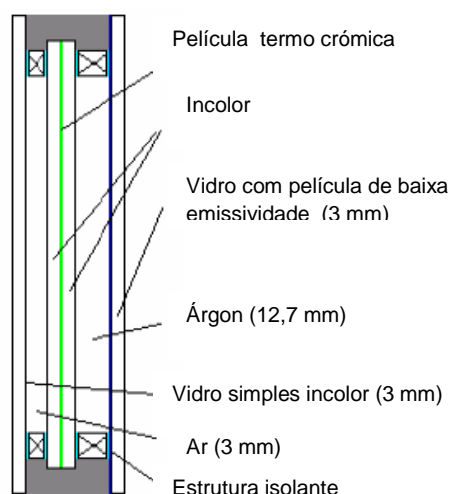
Estrutura do vão envidraçado para as fachadas Nascente e Poente [43].
